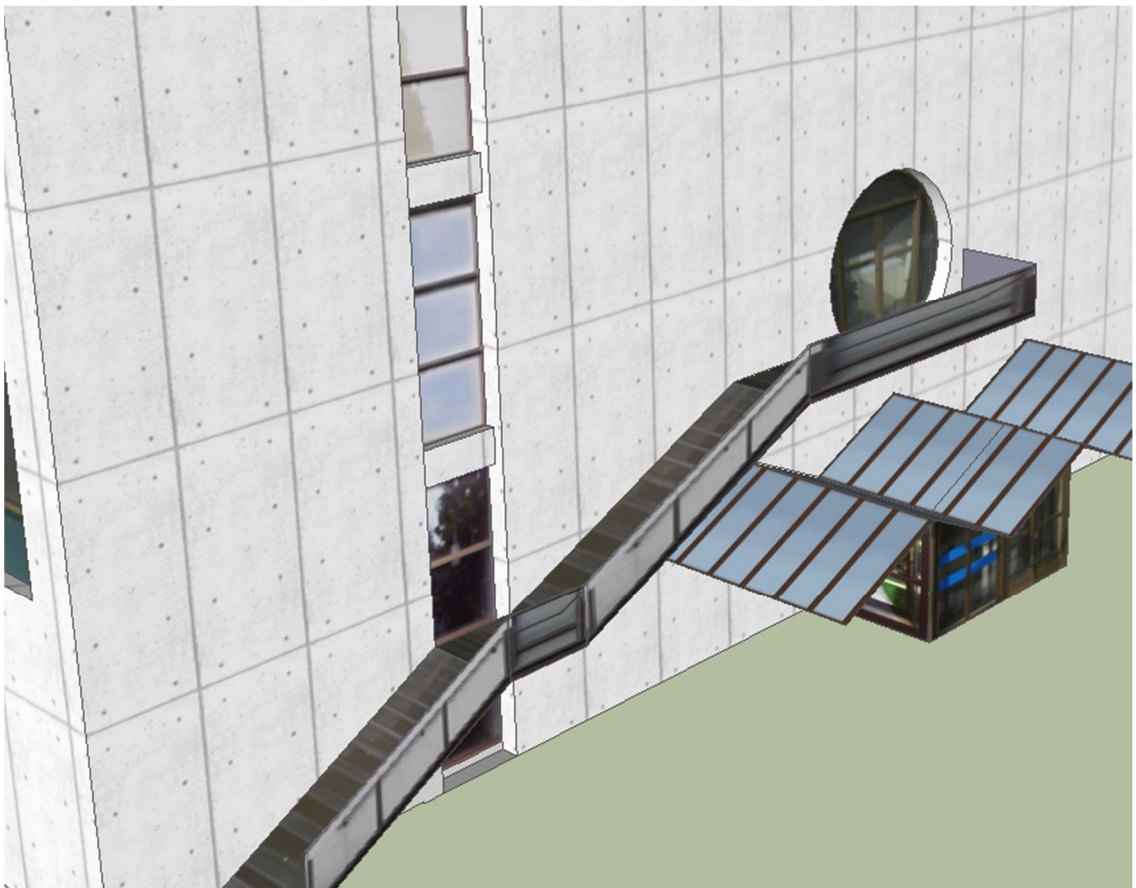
Detalle de la escalera de acceso al primer piso ubicada en la parte posterior del edificio.
